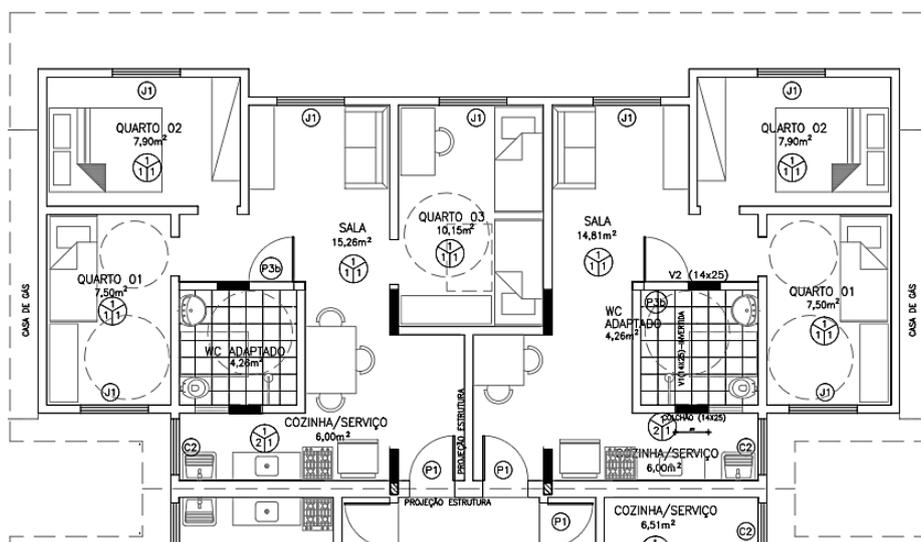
Planta Baixa do bloco tipo C. 2º pavimento. T3b
